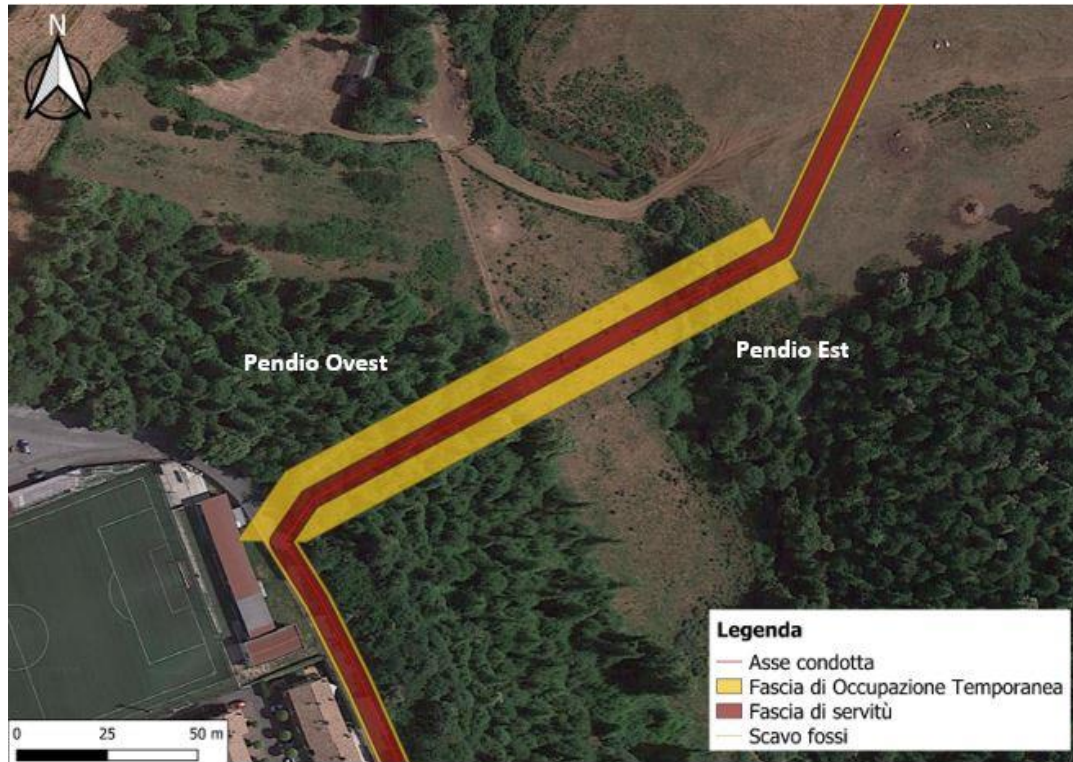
Planimetria attività di lavoro su Fosso Cauzza
